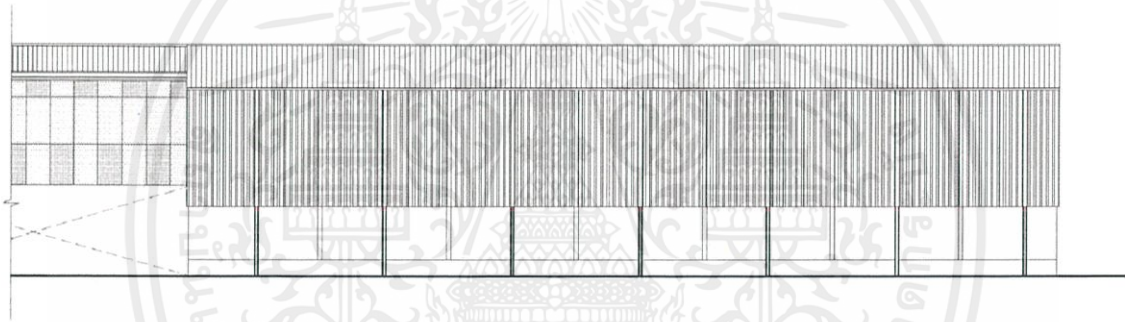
Elevation 1 TAK Sale Office & Warehouse
